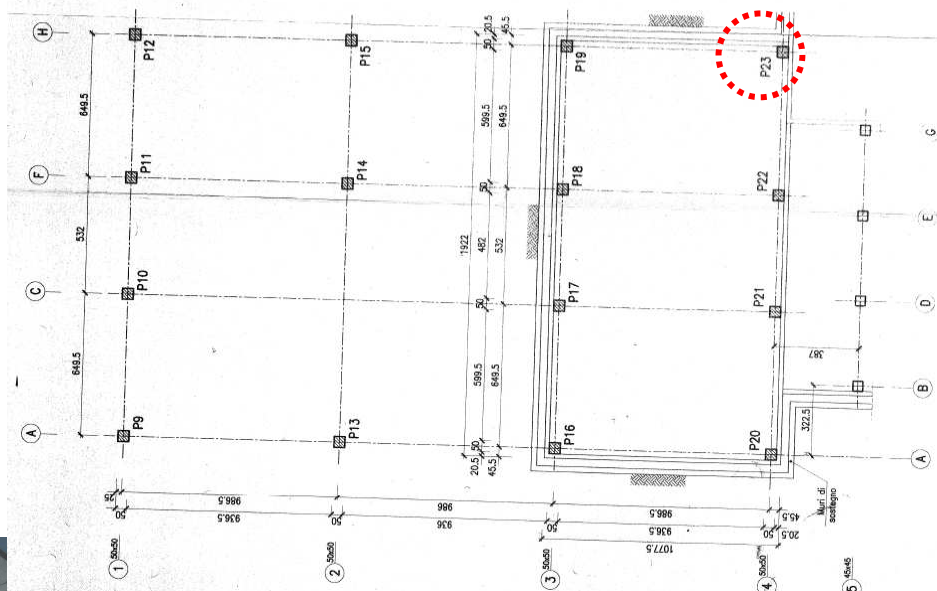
schema planimetrico seminterrato con numerazione pilastri
